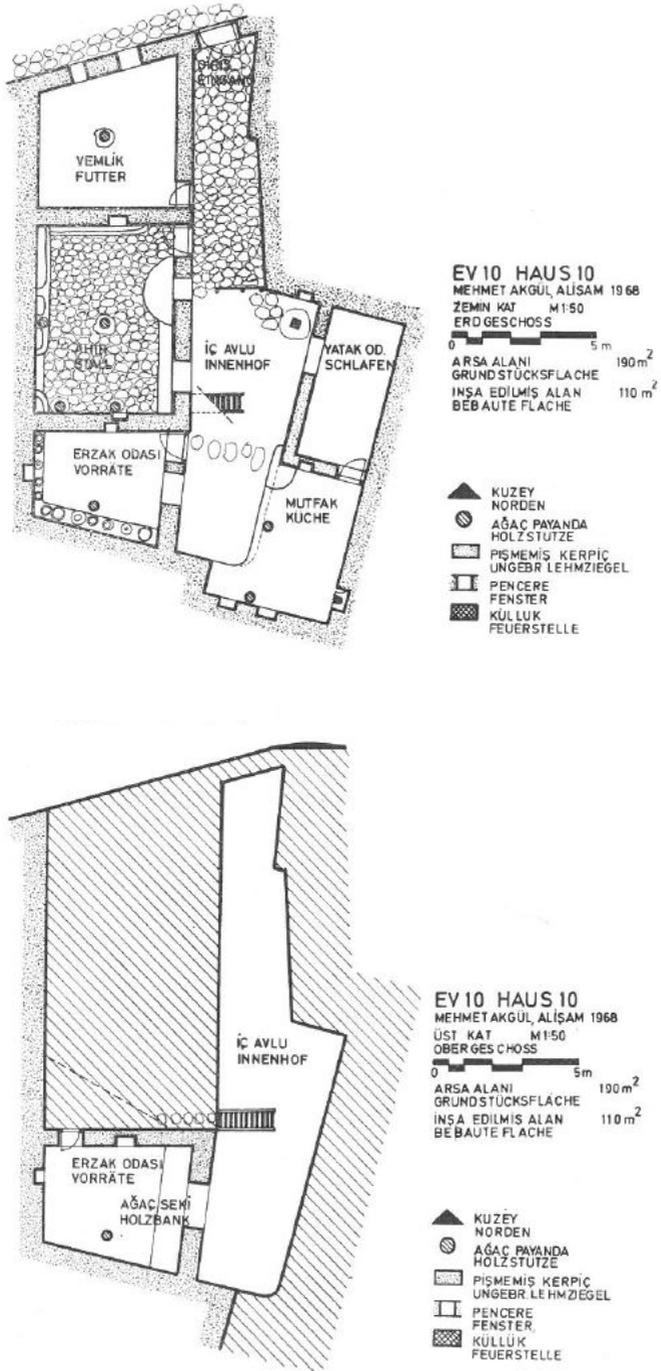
Grundriss Haus 10 ohne Diele
